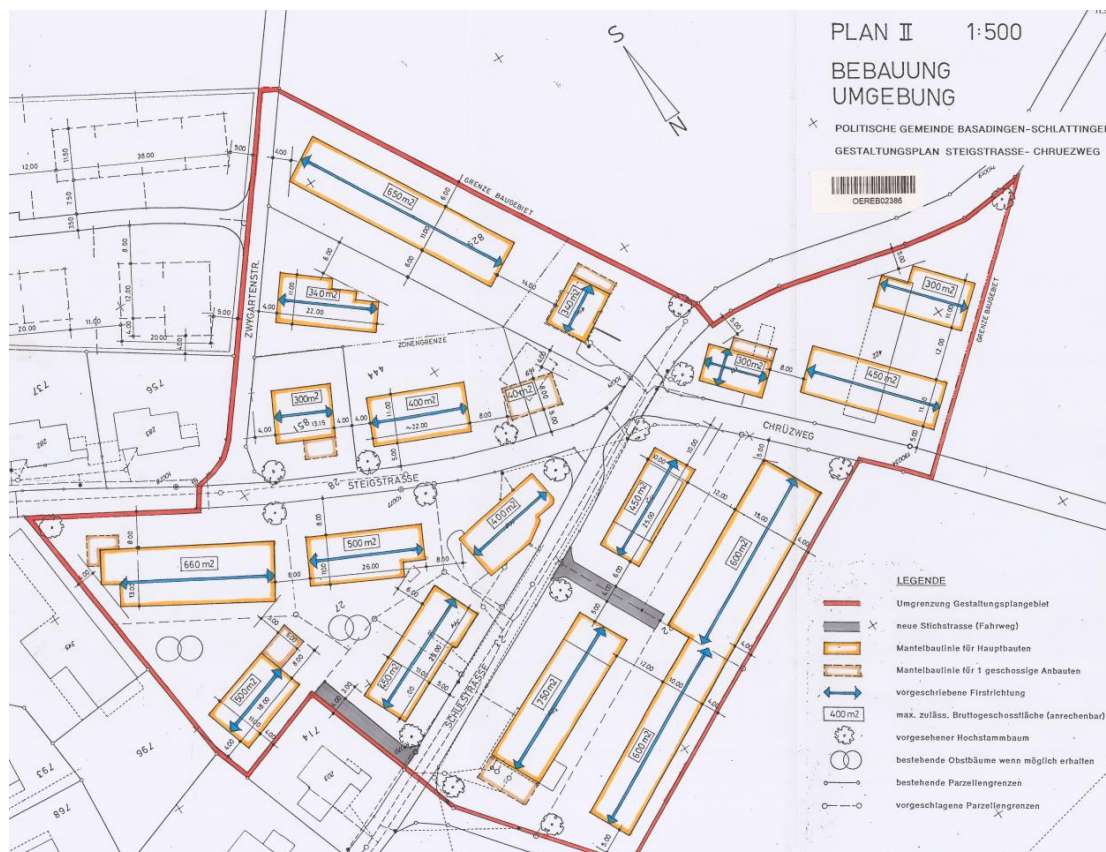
Bebauungs- und Umgebungsplan GP 'Steigstrasse - Chrüzweg'
